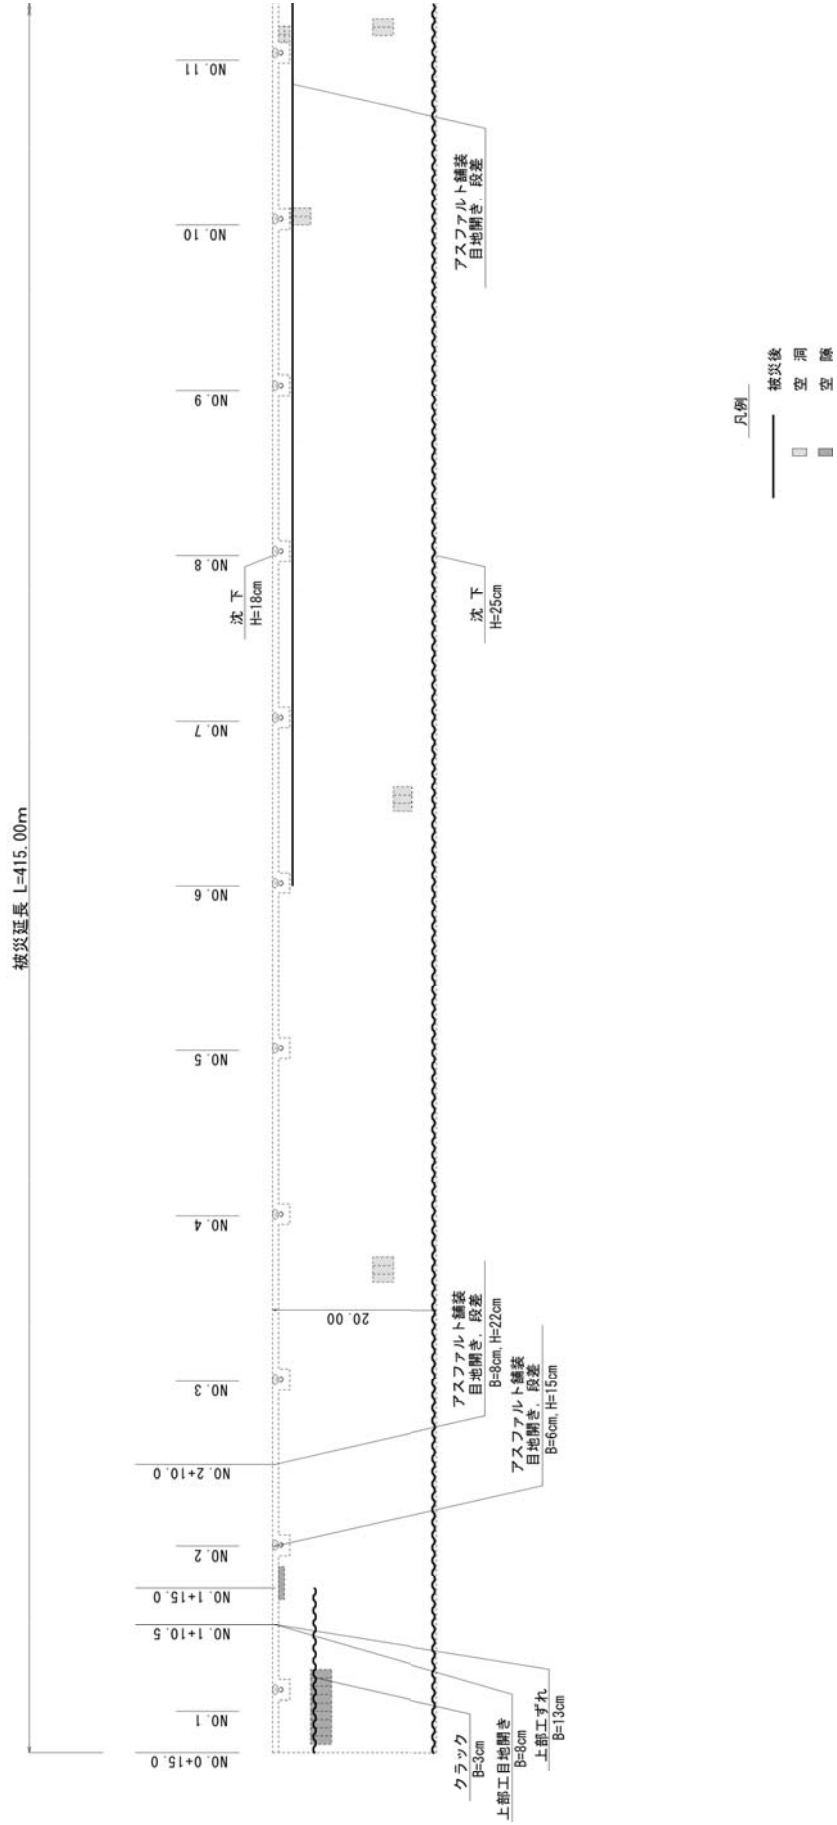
(a) 香椎パークポート地区北-7.5m 岸壁の被災状況平面図①
